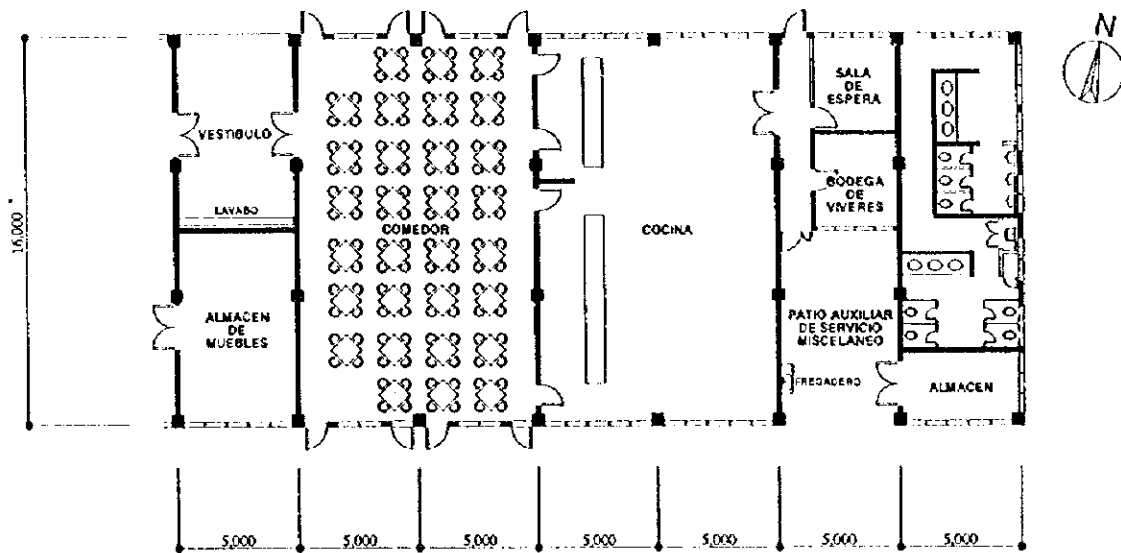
Plano del plan del edificio de comedor y cocina
